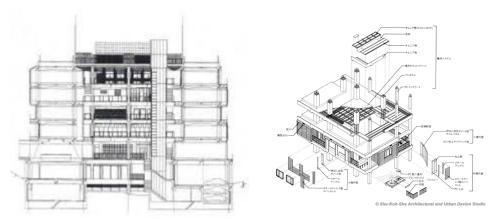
Referente Next 21 Fuente: Wiki.eaud.pucv
